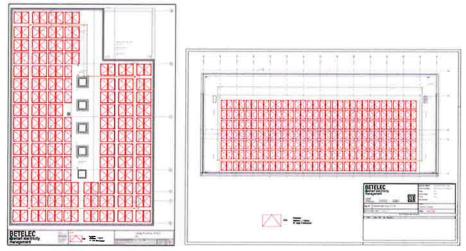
Implantation maximale en toiture (Salle de gym et Collège)
